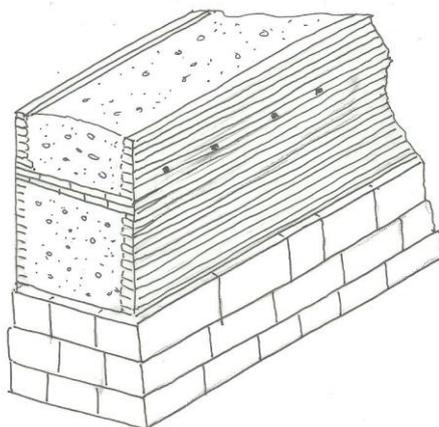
Muro Romano de Cimentación. s. IV. Mark, Robert (2002) "Tecnología Arquitectónica hasta la Revolución Científica".
